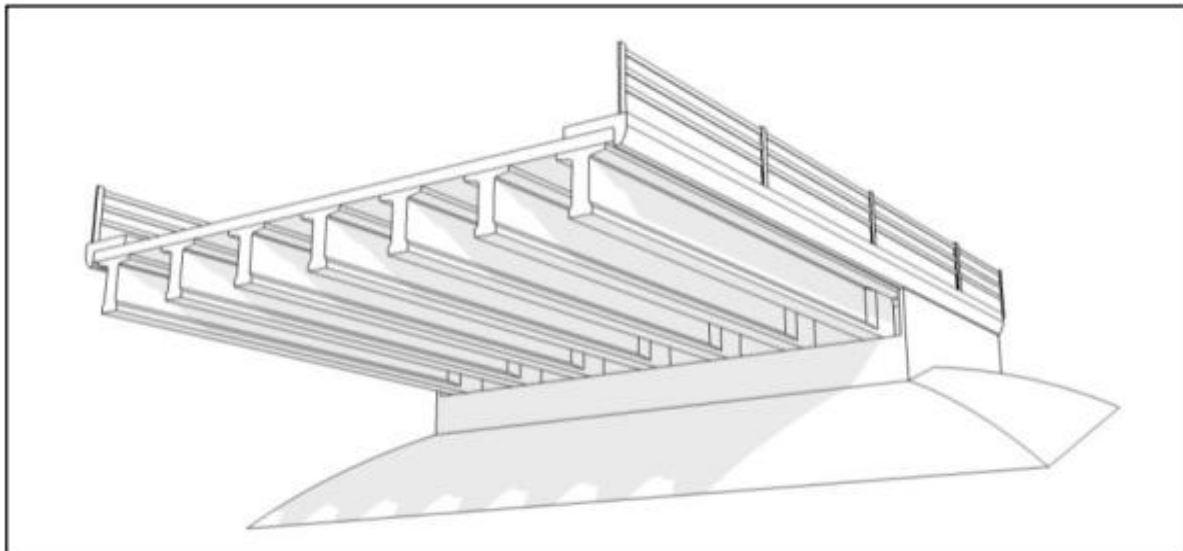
Morphologie générale d'un pont à poutres en béton précontraint
